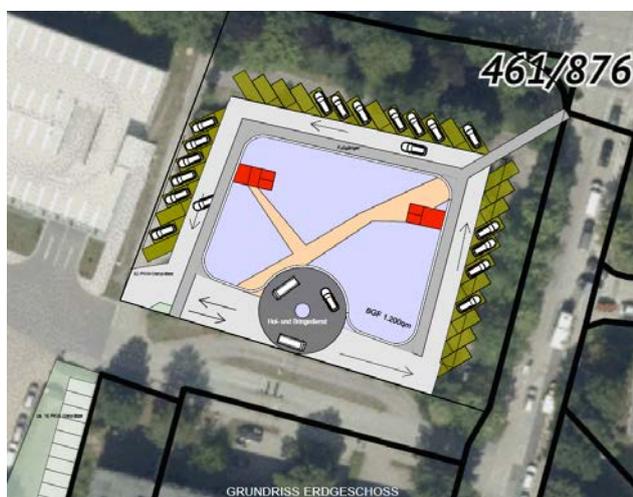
Grundrisssskizze EG; Quelle: Tilo Ries
